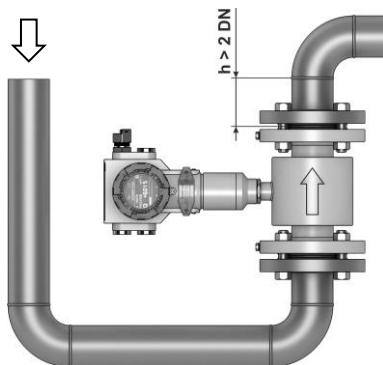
Монтаж расходомера в трубопровод с нисходящим потоком
